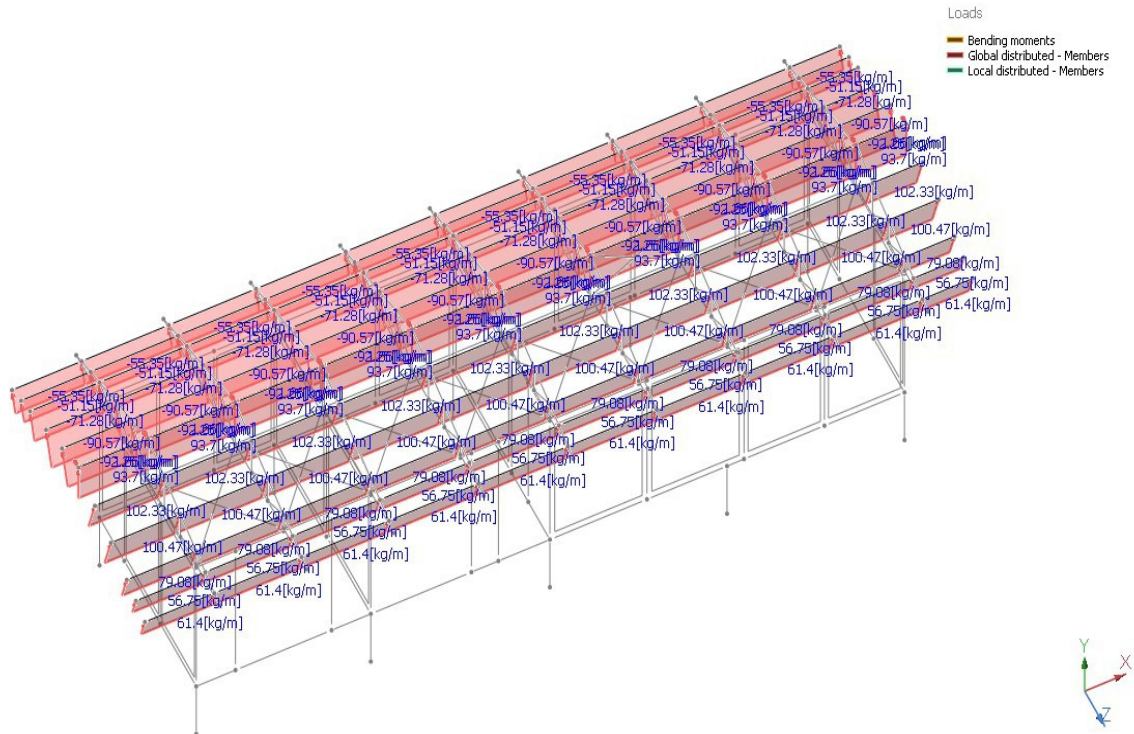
Cargas en cubierta debidas al viento en dirección Z con GCpi+ (Wzp1).
